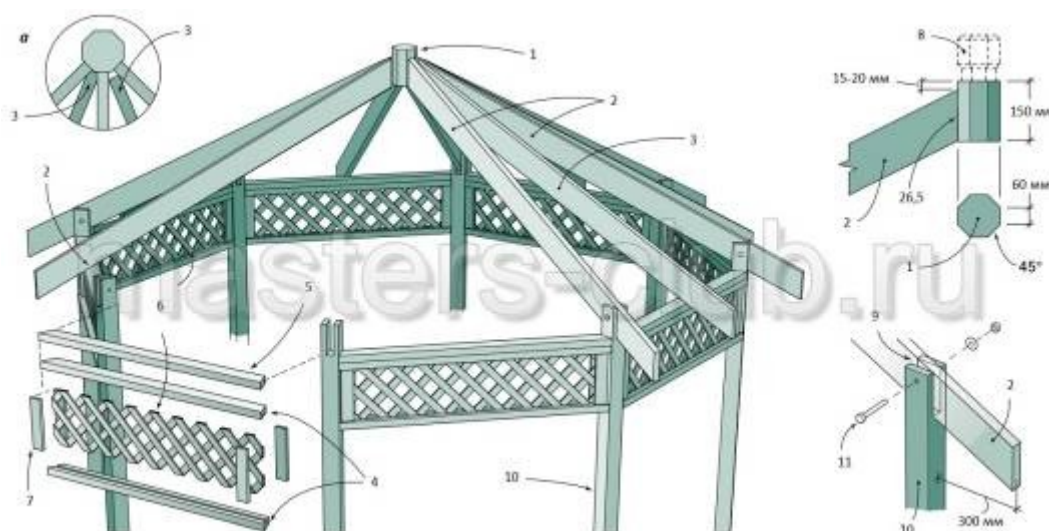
Стропильная система и карниз беседки: 1 — бабка подвесных стропил; 2 — стропила; 3 — промежуточные стропила; 4 — верхняя и нижняя перекладины карниза; 5 — верхняя накладка карниза; 6 — решетка из тонких реек; 7 — накладные планки; 8 — шпиль; 9 — паз под стропило; 10 — столб; 11 — болт с шайбой и гайкой.
